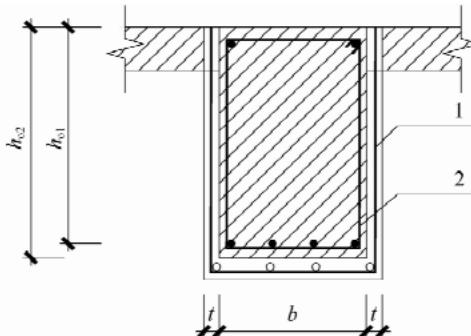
高延性混凝土三面围套加固钢筋混凝土受弯构件示意图
